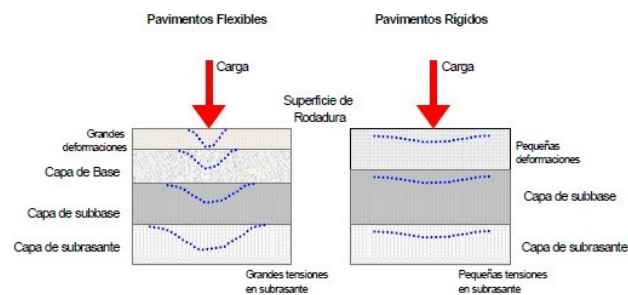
Esquema de comportamiento de pavimentos flexibles y rígidos
